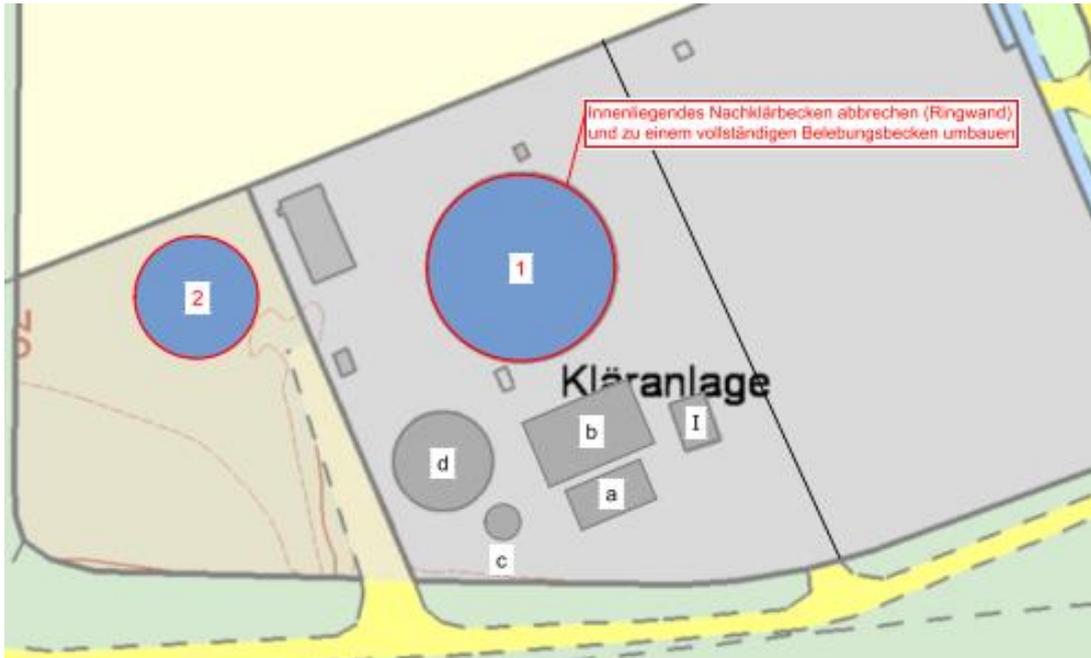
Lageplan Variante 4: Erweiterung KA Gesmold
